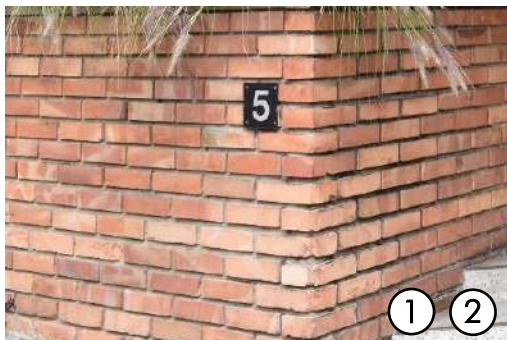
Fotografías detalle de patologías Edificio Giraldo. Edición: La Autora (2021).
